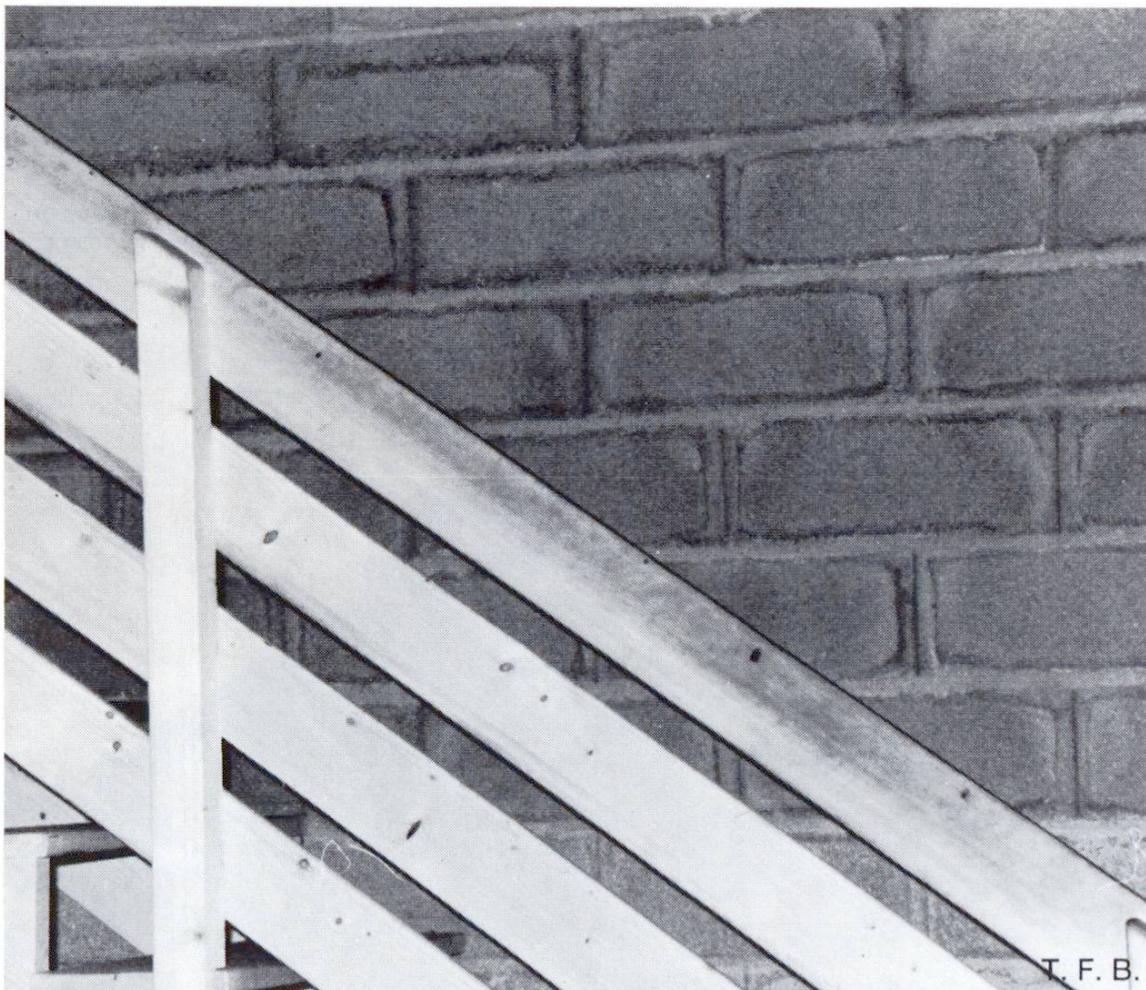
Beton-Sichtmauerwerk mit einer verdünnten Dispersion gestrichen.
